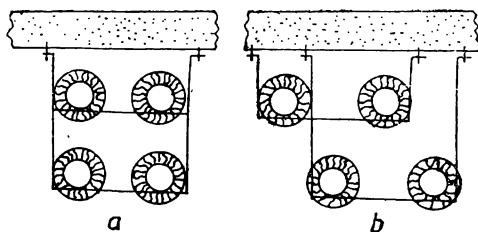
Gruparea conductelor montate în două planuri orizontale:
